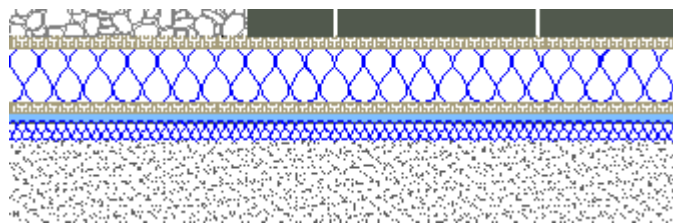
Aplicação de isolante térmico sobre impermeabilização existente
